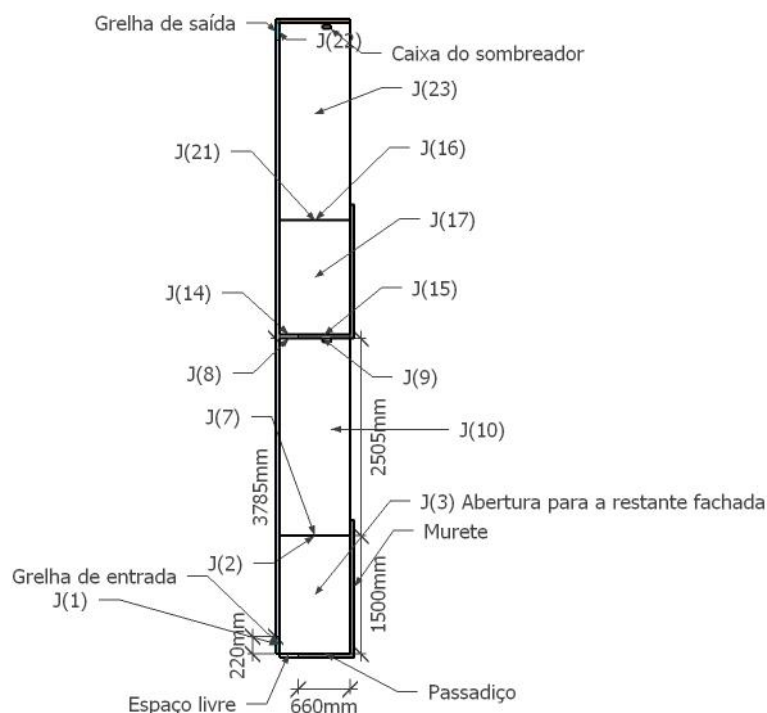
Esquema do modelo simplificado para as fachadas SO/NE do exterior para o interior (dimensões não proporcionais).
